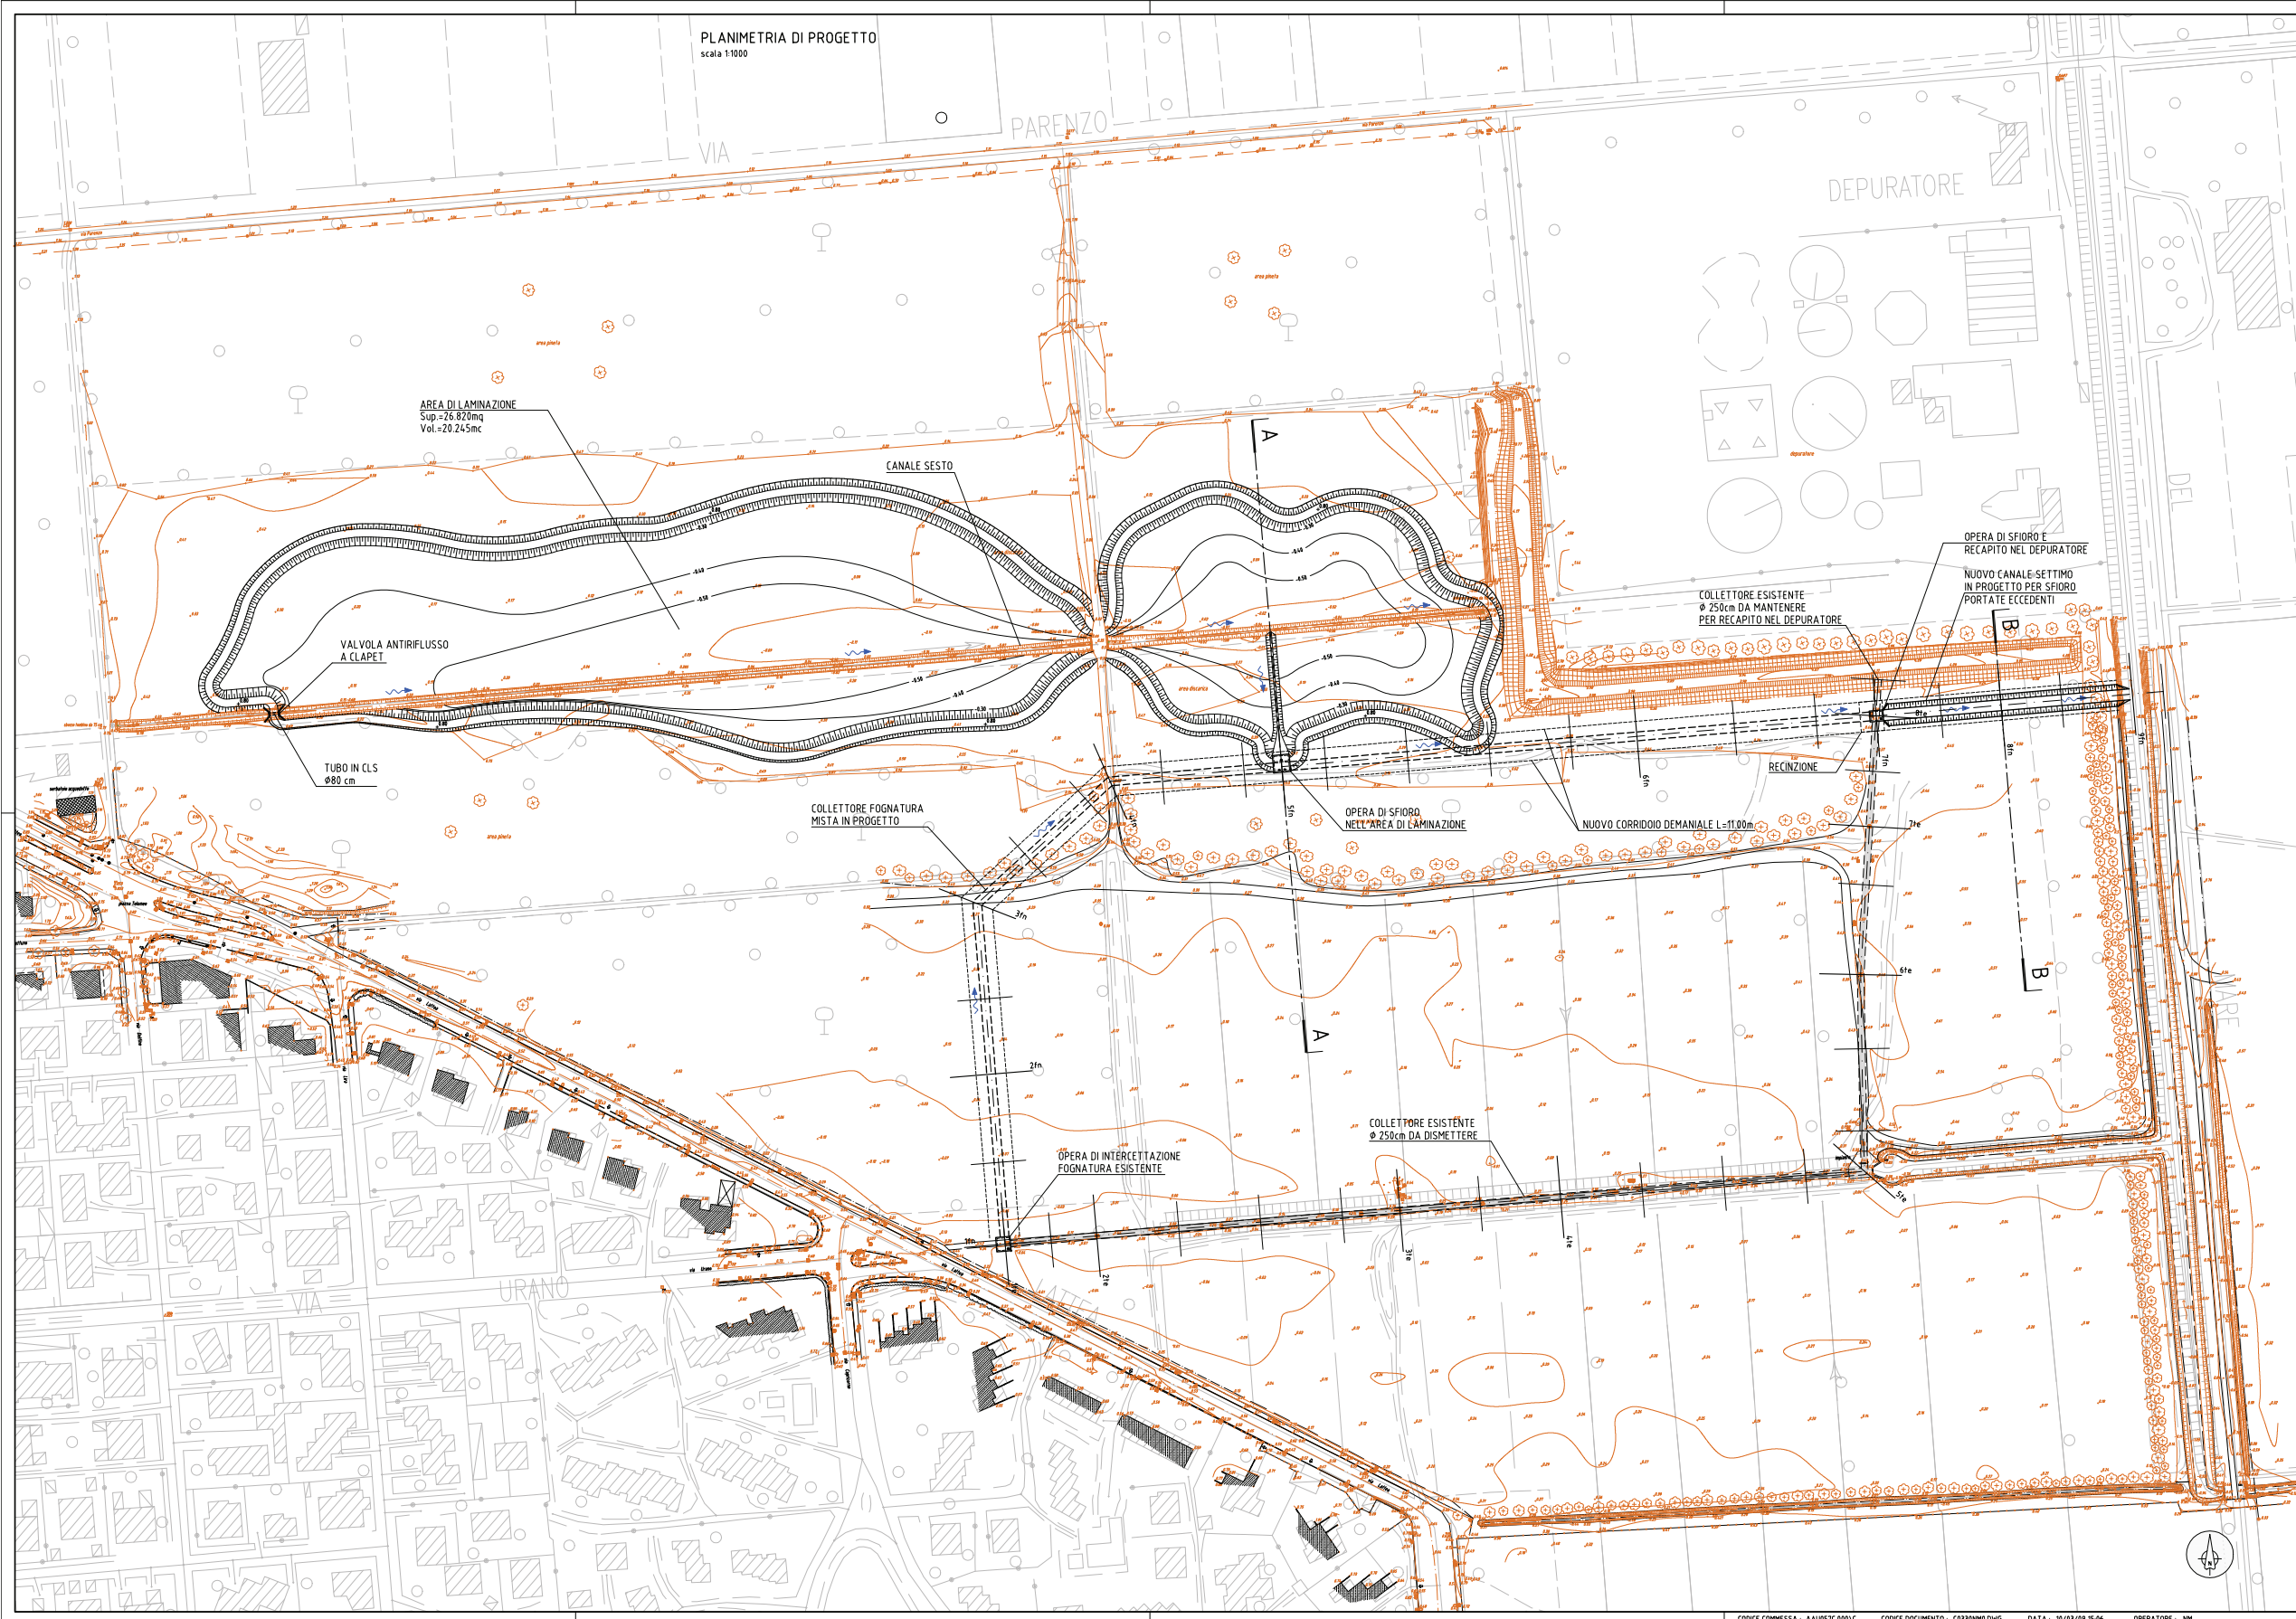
Planimetria generale con indicazione delle diverse viabilità di progetto
